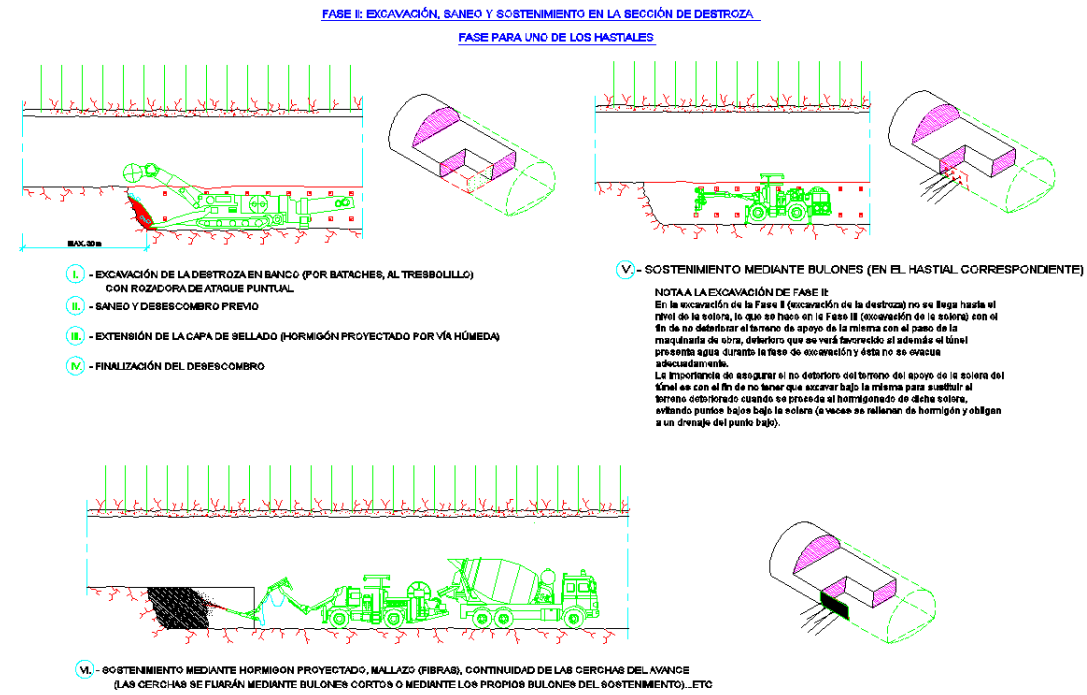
Fase de excavación en la sección de Destroza, primer hastial.
